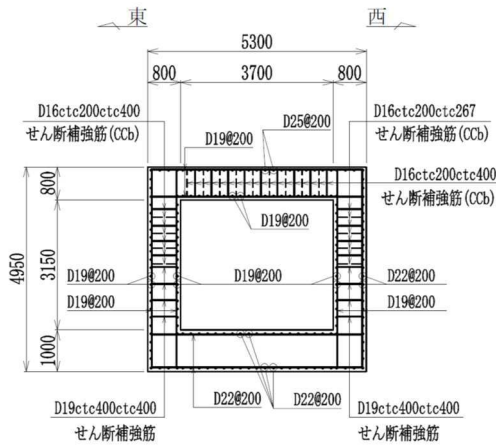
復水貯蔵タンク基礎 概略配筋図(4-4 断面)
